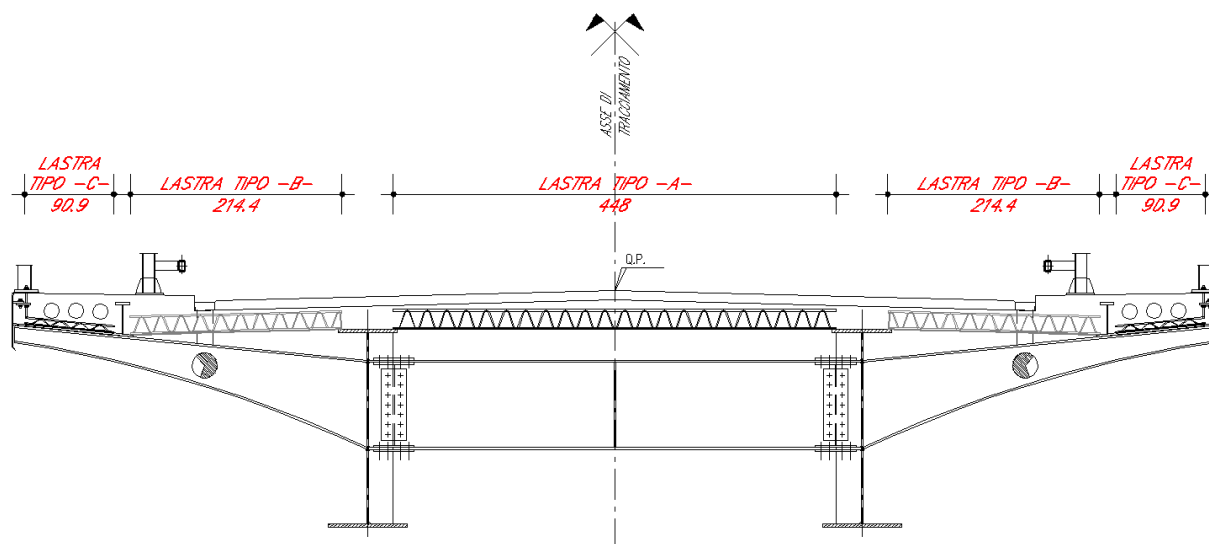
Tipologie di lastre e loro disposizione sulla sezione trasversale dell'impalcato
